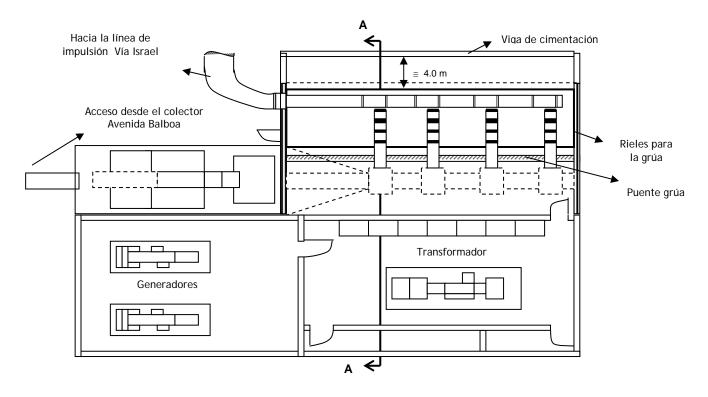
Estación de Bombeo Paitilla - Vista en Planta
